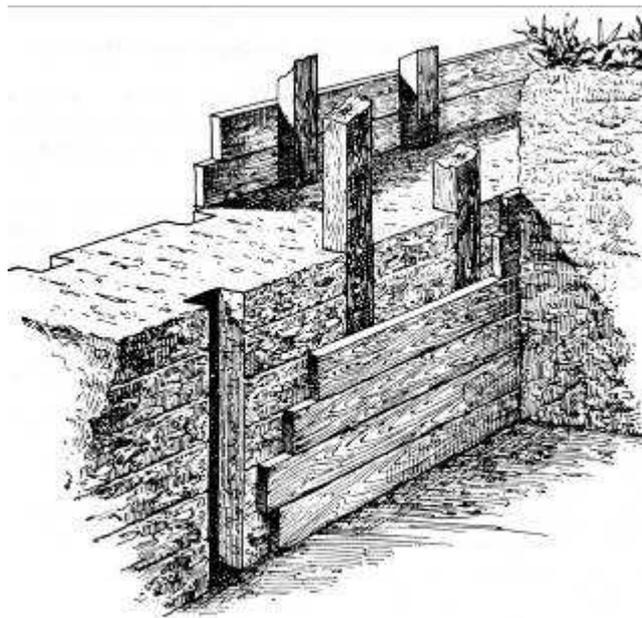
Fondazione in cavo armato (LUGLI 1957)
